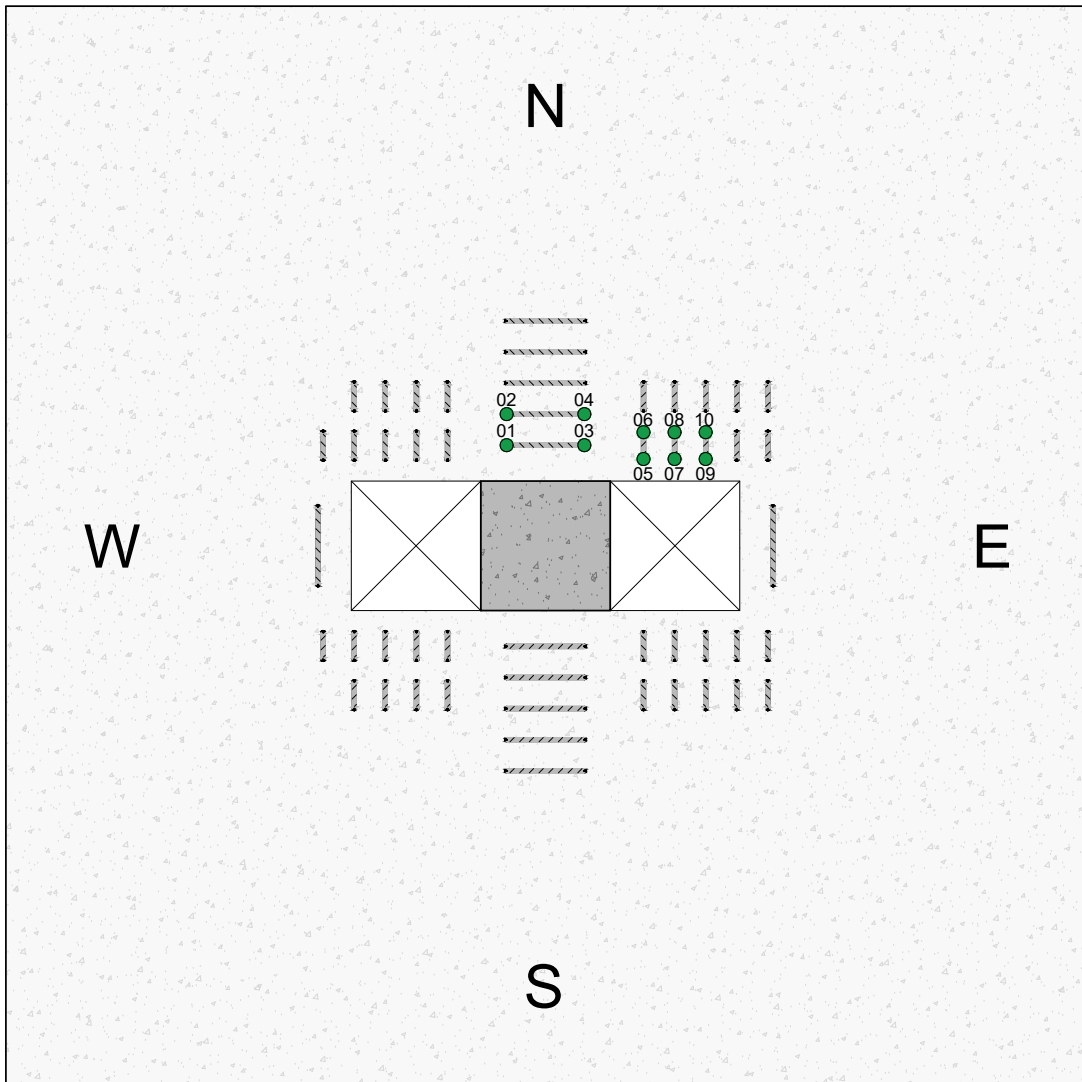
Posicionamento dos extensômetros nos estribos da laje LFE3 [mm]
